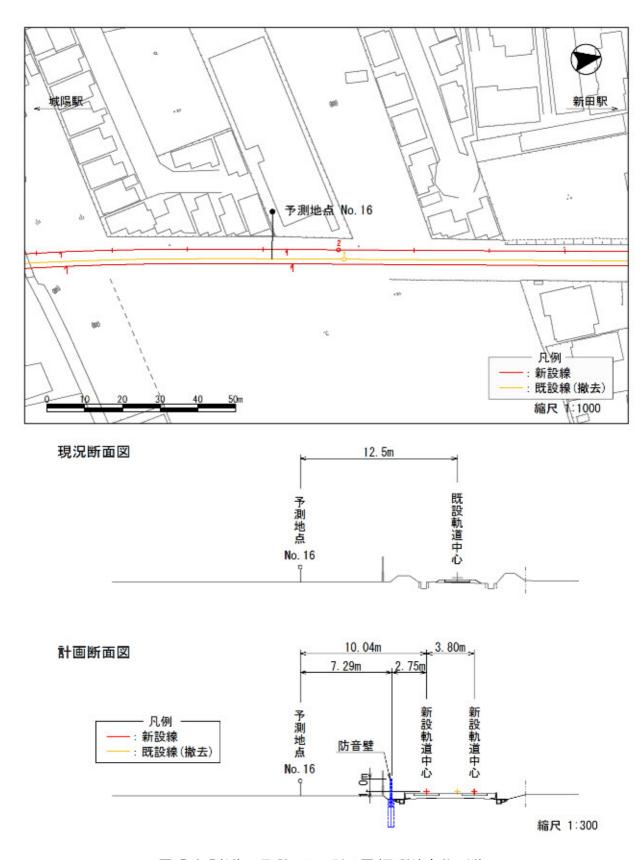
(16) 予測平面・断面図(予測地点 No.16)
